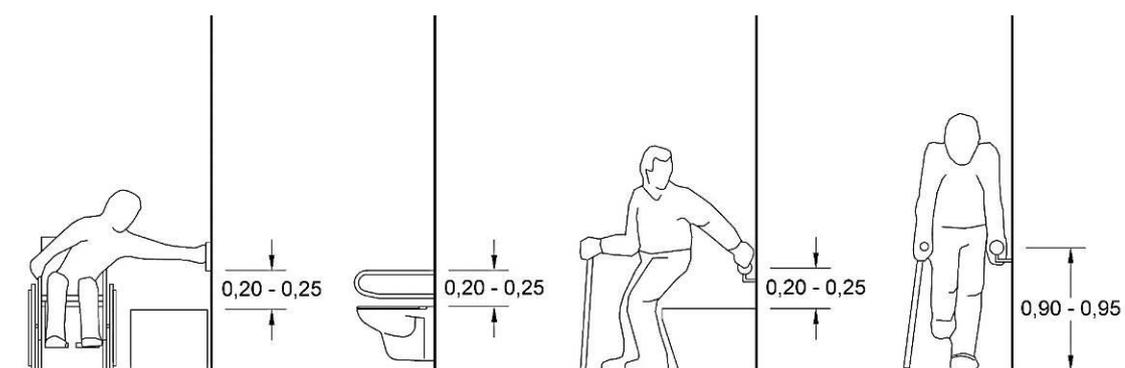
20. Altura de colocación de las barras de soporte (cotas en metros)
